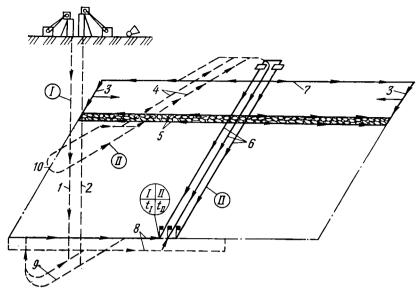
Вариант схемы строительства шахт группы I с этажным способом подготовки пластов и разработкой этажей длинными столбами по простиранию:
